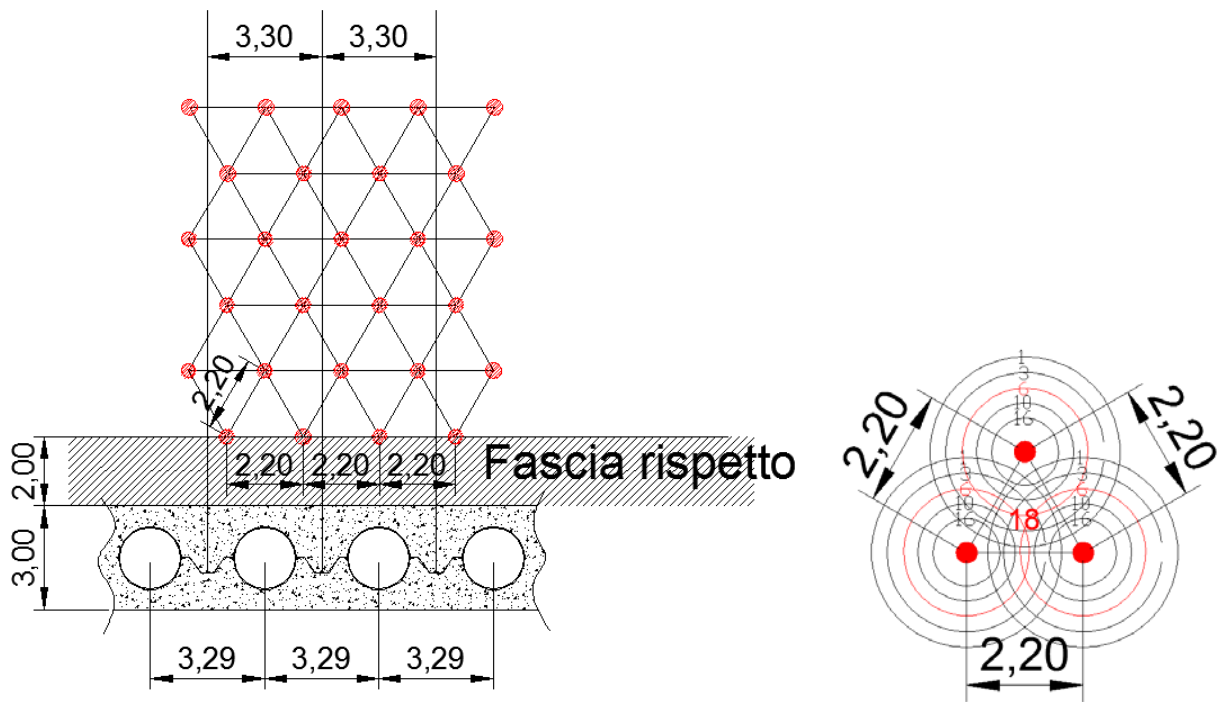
Sx) Posizione delle verticali di trattamento con vibroflottazione tra gli elementi strutturali della banchina; Dx) Efficacia del trattamento con la maglia proposta
